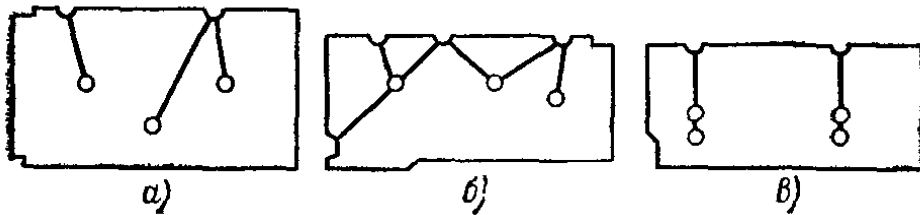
Примеры выполнения каналов в железобетонных панелях перекрытий (а и б) и стеновых панелях (в)
